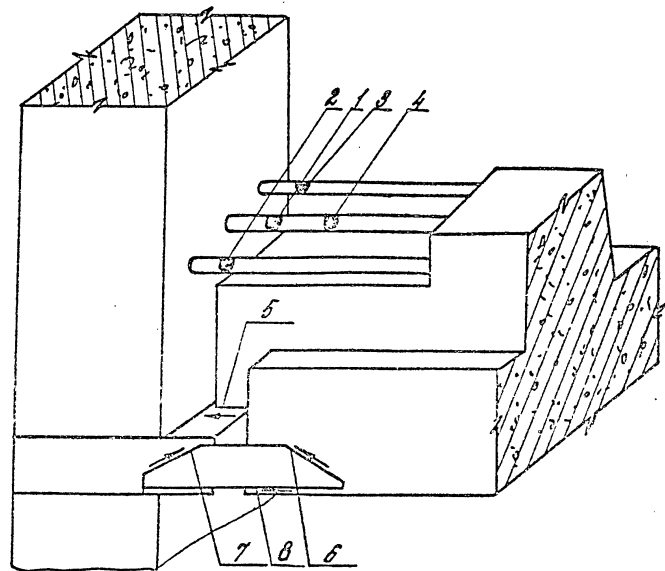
Порядок выполнения сварных соединений в узле сопряжения ригеля с плотиной.
